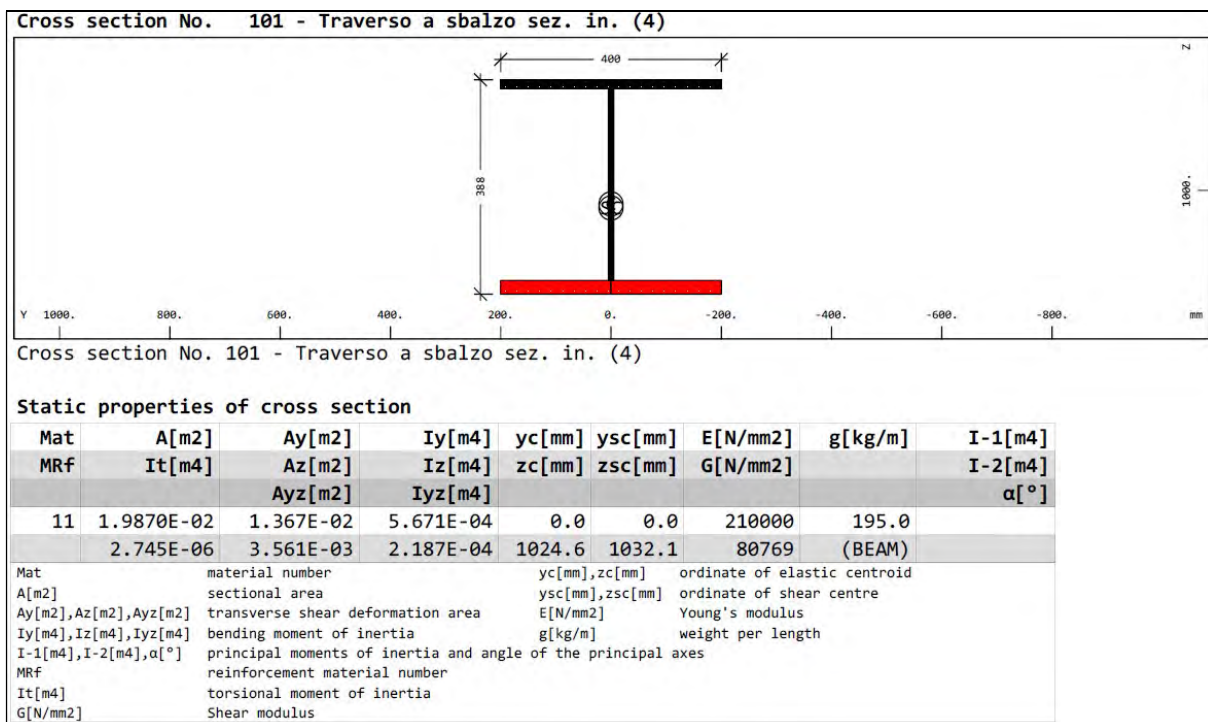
Trave a sbalzo – “Sezione di altezza var.”
